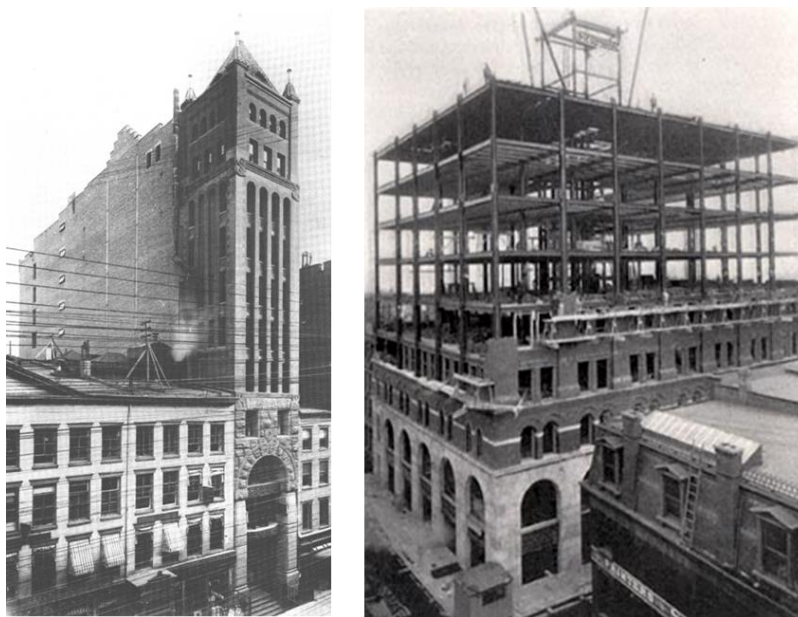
Tower Building, NY, 1889, primeiro arranha-céus estrutura em aço (demolido 1914)
